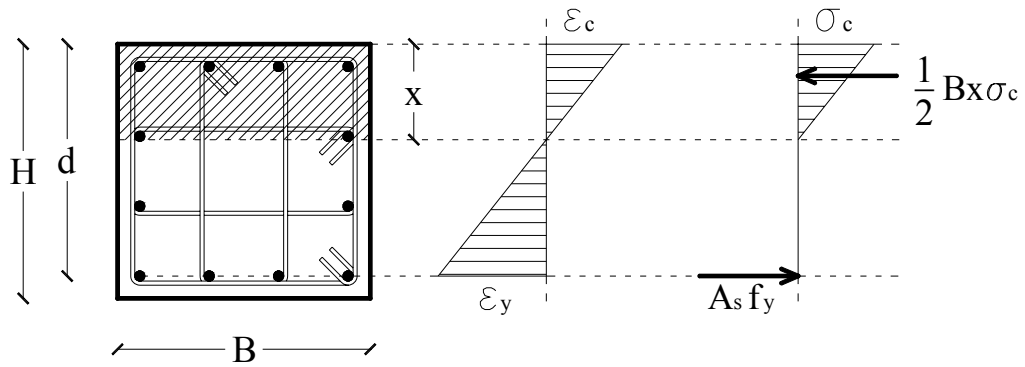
Limite di primo snervamento per la sezione trasversale dei pilastri.
